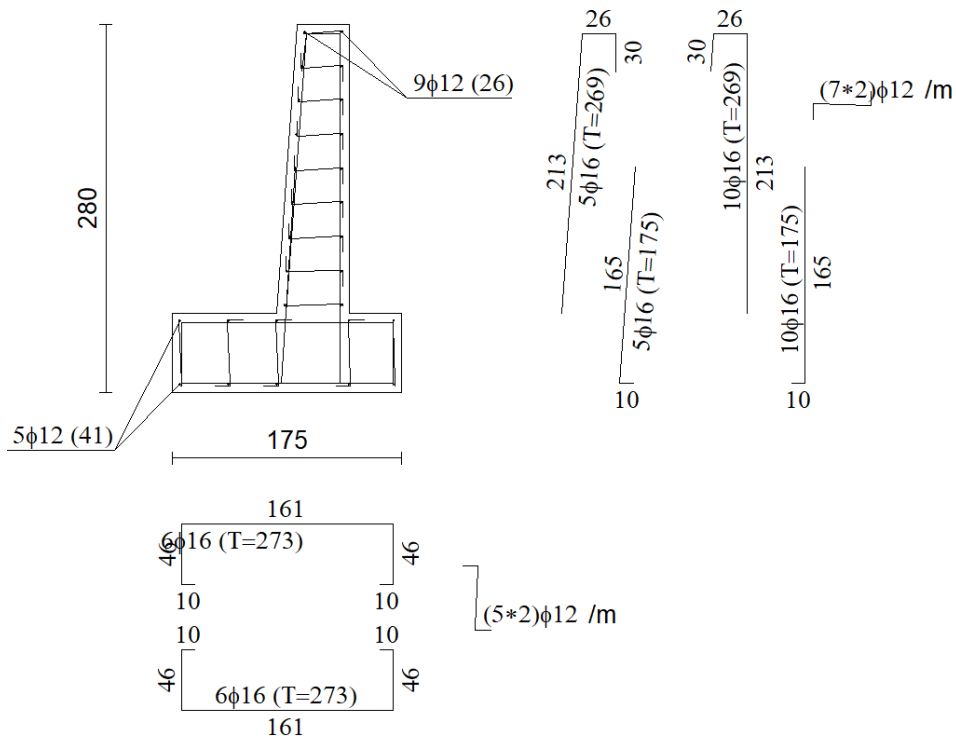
Armatura muro di sostegno Tipo 3 - Viabilità NV02B.
